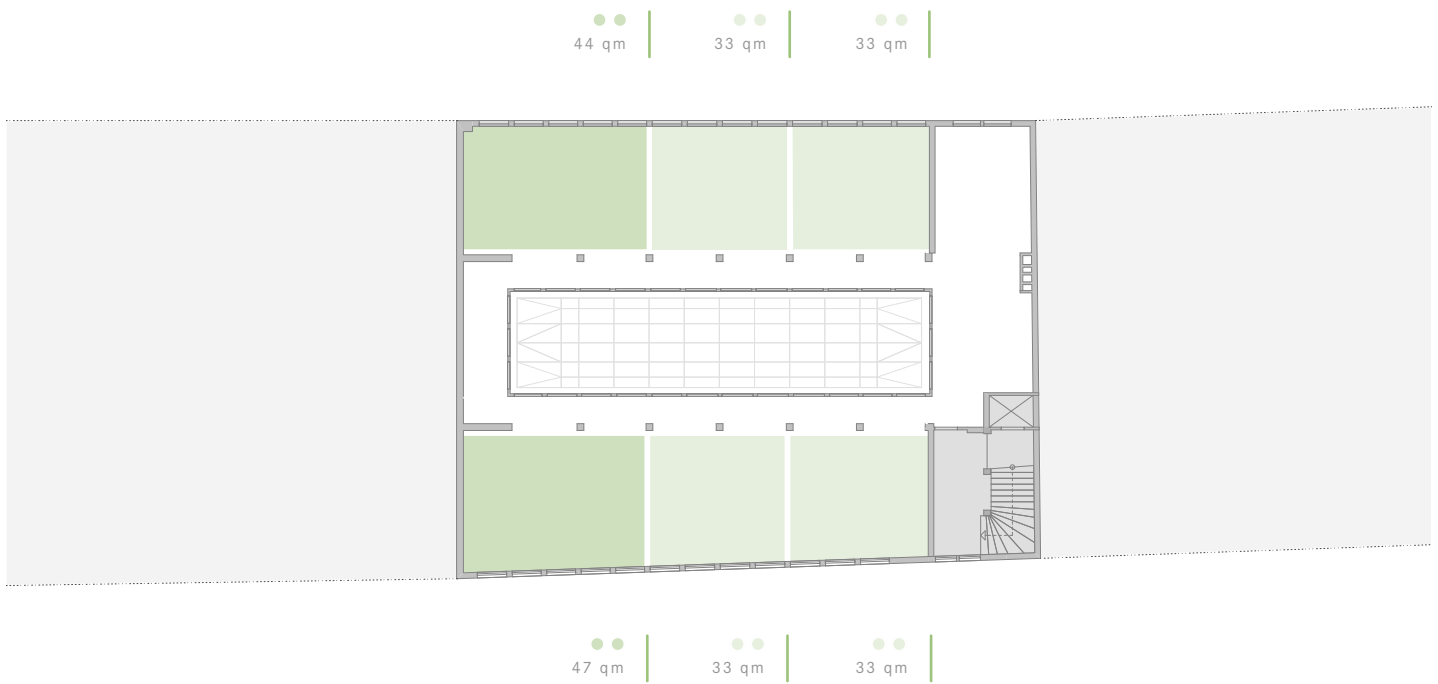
Grundriss Umbau - Wohnungsaufteilung
